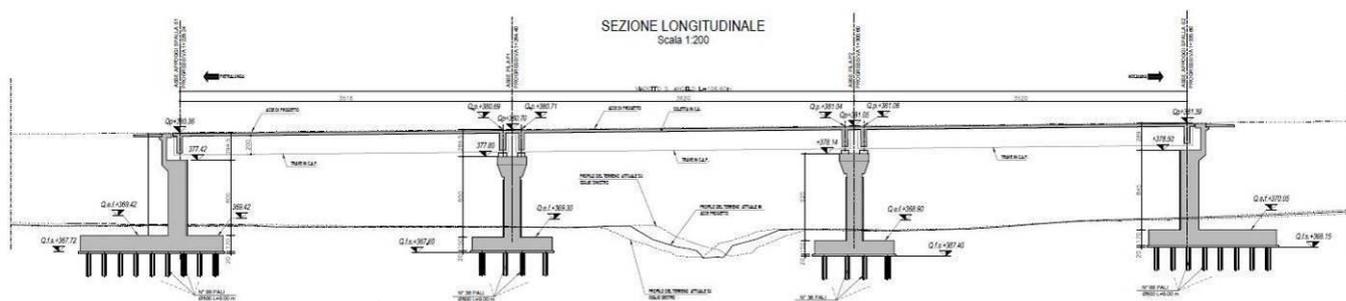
SEZIONE LONGITUDINALE VIADOTTO S.ANGELO
